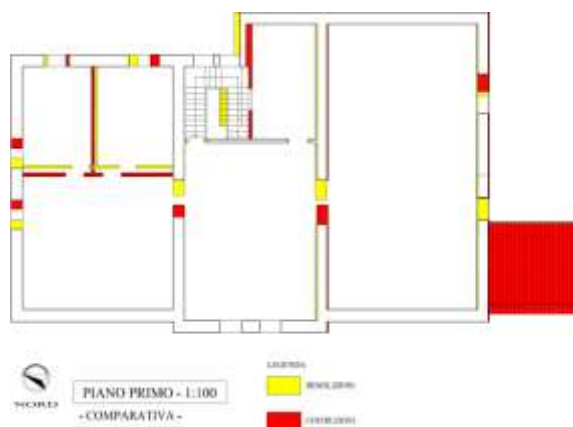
Planimetria P.1° con evidenziate demolizioni e costruzioni effettuate (fuori scala) – ([Allegato N.2](#))
